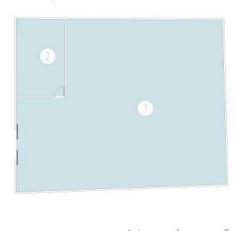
Planta primer nivel Bloque No.35. Fuente: Equipo Diagnóstico.
